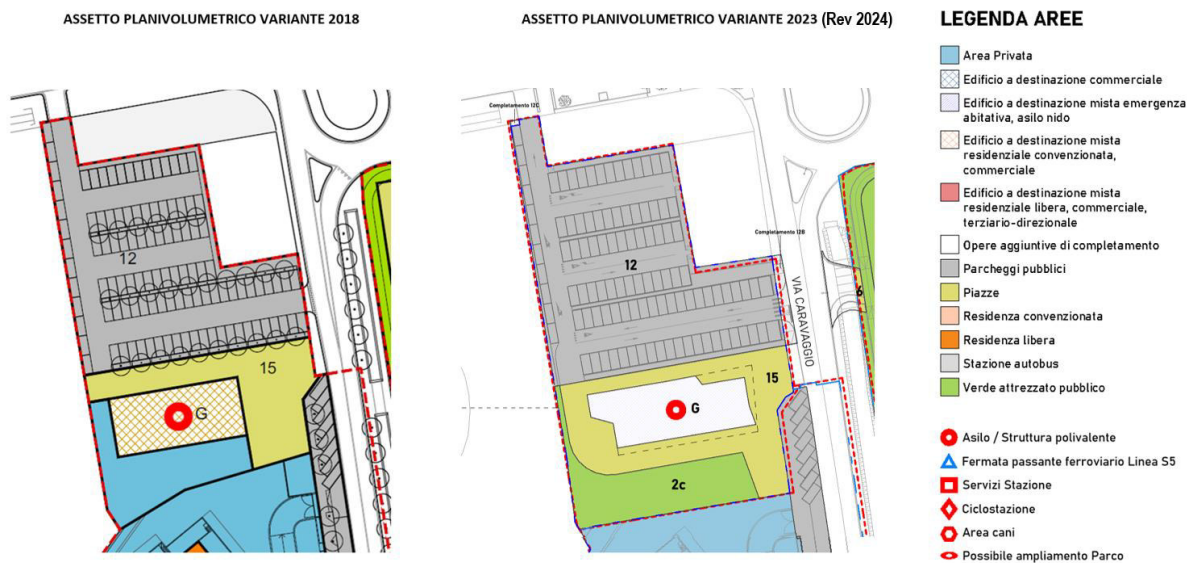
| Lotto 6: Confronto tra Varianti 2018-2023 - Planimetria destinazioni e indici urbanistici di progetto
